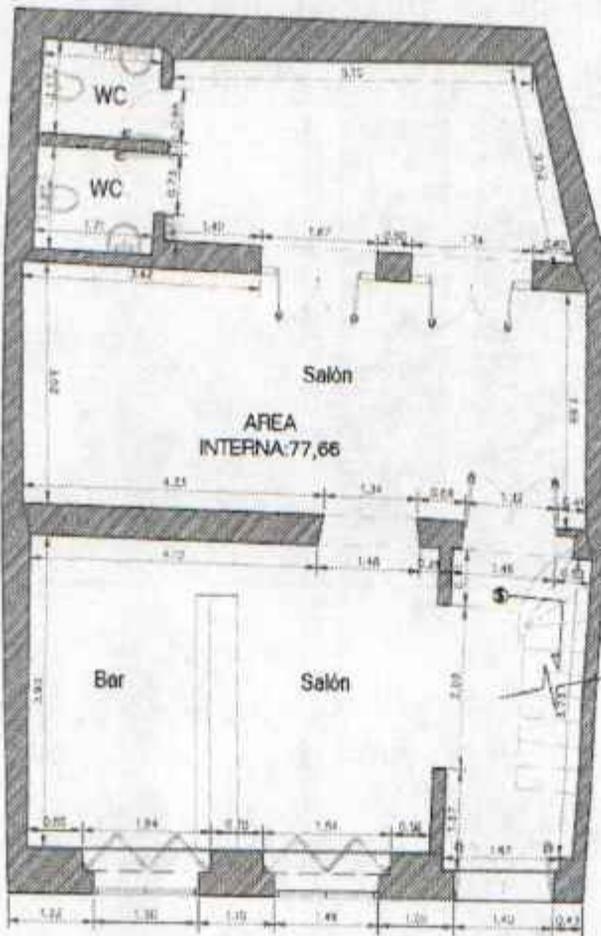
Plano RESTAURANTE JUANA ICACO - Área privada.
